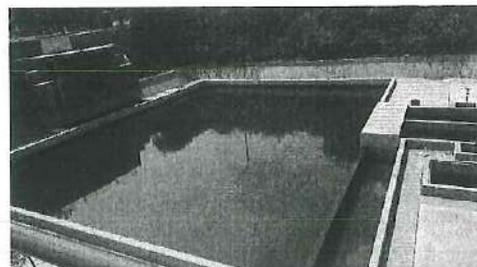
Vista general de la planta de recuperación de agua de lavado de filtro.
